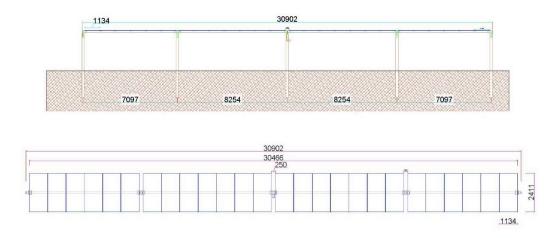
Tipologico struttura di sostegno moduli – prospetto e pianta
